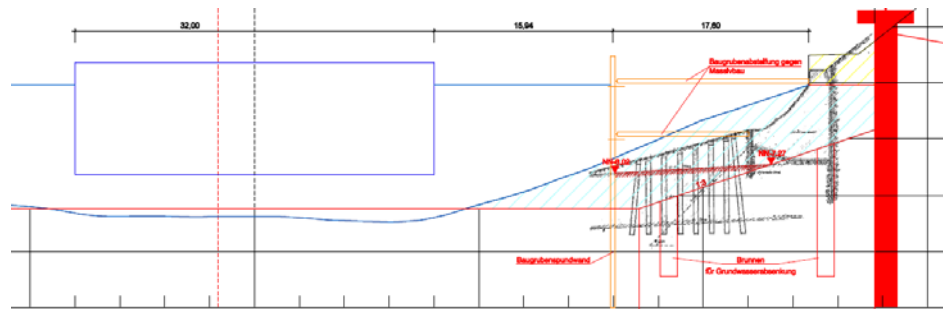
Rückbau Notfundamentreste in trockener Baugrube (Querschnitt)
